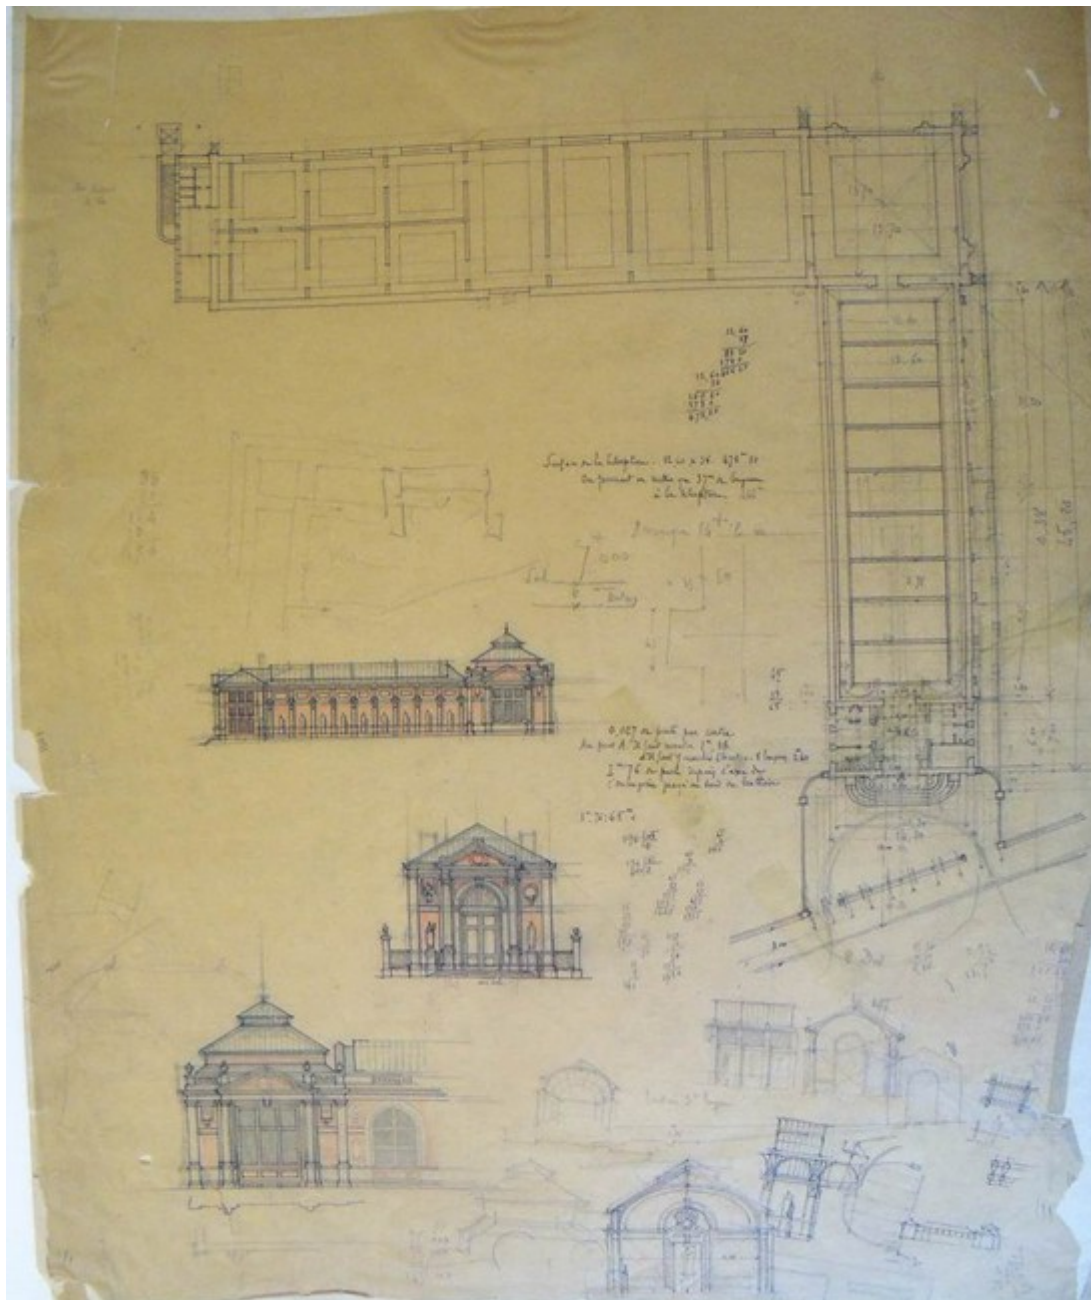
Charles Gondoin, [études pour la transformation de l'orangerie du Luxembourg : plan du rez-de-chaussée, élévations de la façade ouest, de la façade sud, de la façade nord du pavillon d'entrée, études de coupes transversales sur l'orangerie et la galerie de sculpture], s.d. [ca. 21/04/1884] (Sénat/DAPJ, n°60, cote provisoire).
